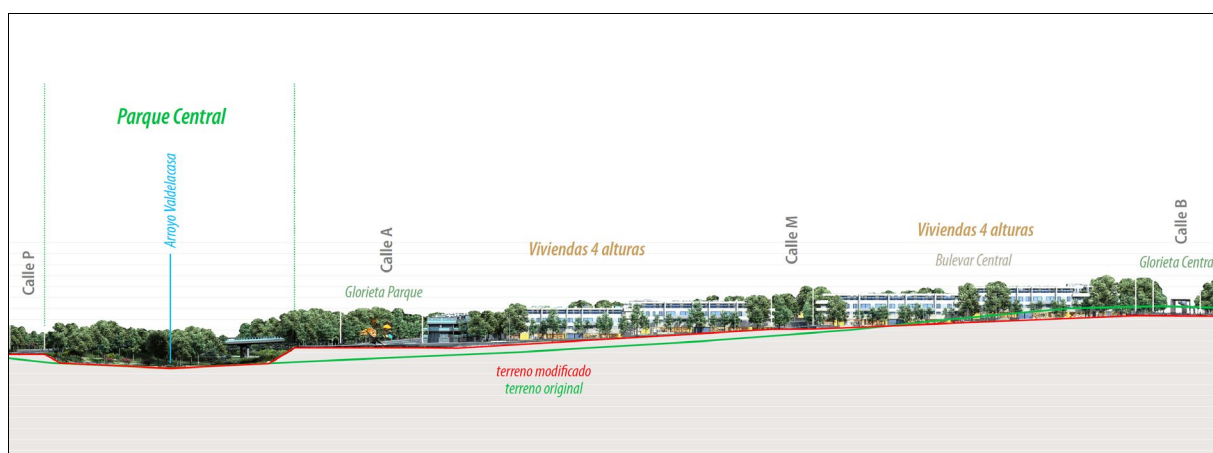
Sección transversal este-oeste desde la calle P hasta la calle B
